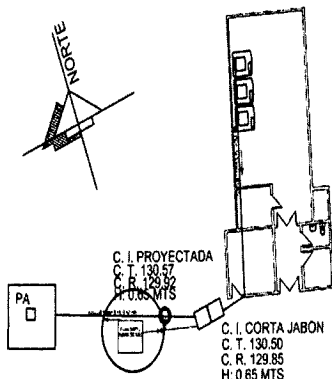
Plano Sistema de Alcantarillado- Lavandería
